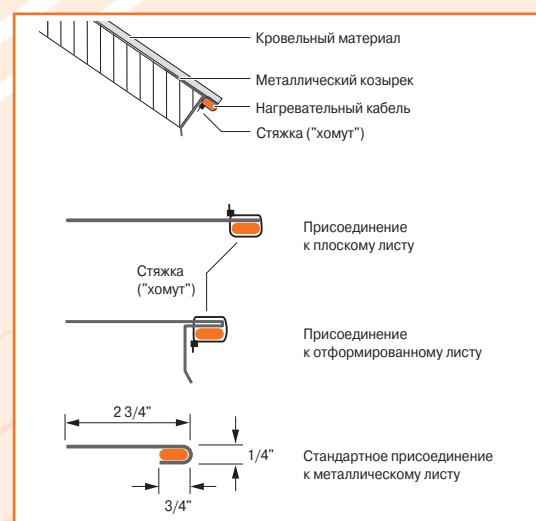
Методы крепления нагревательного кабеля на кромке кровли
